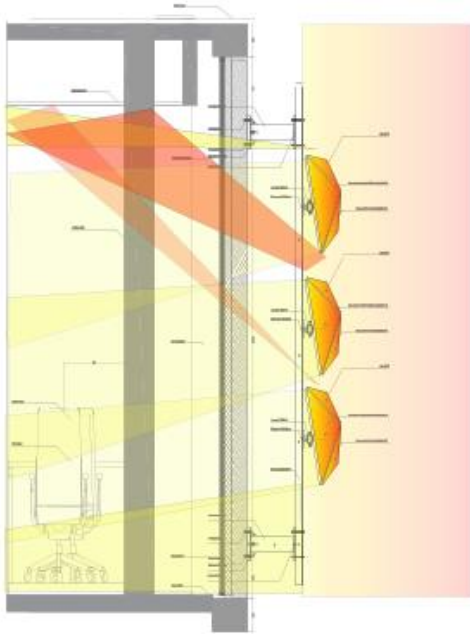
Ingreso Solar fachada carrera 80A. Elaboración propia.
